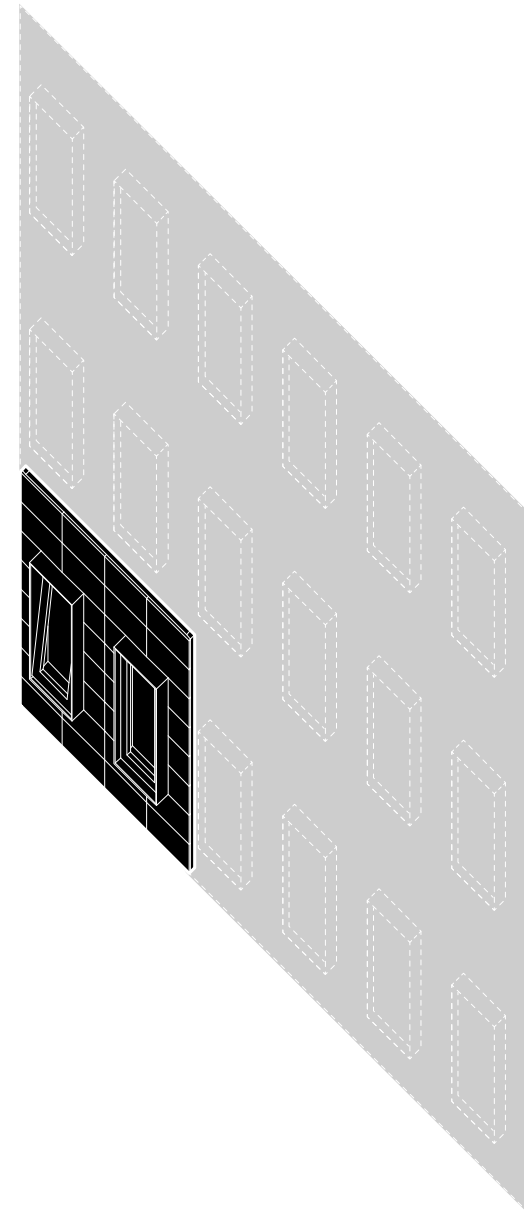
Esquema de mock-up como sección de un proyecto mayor.
